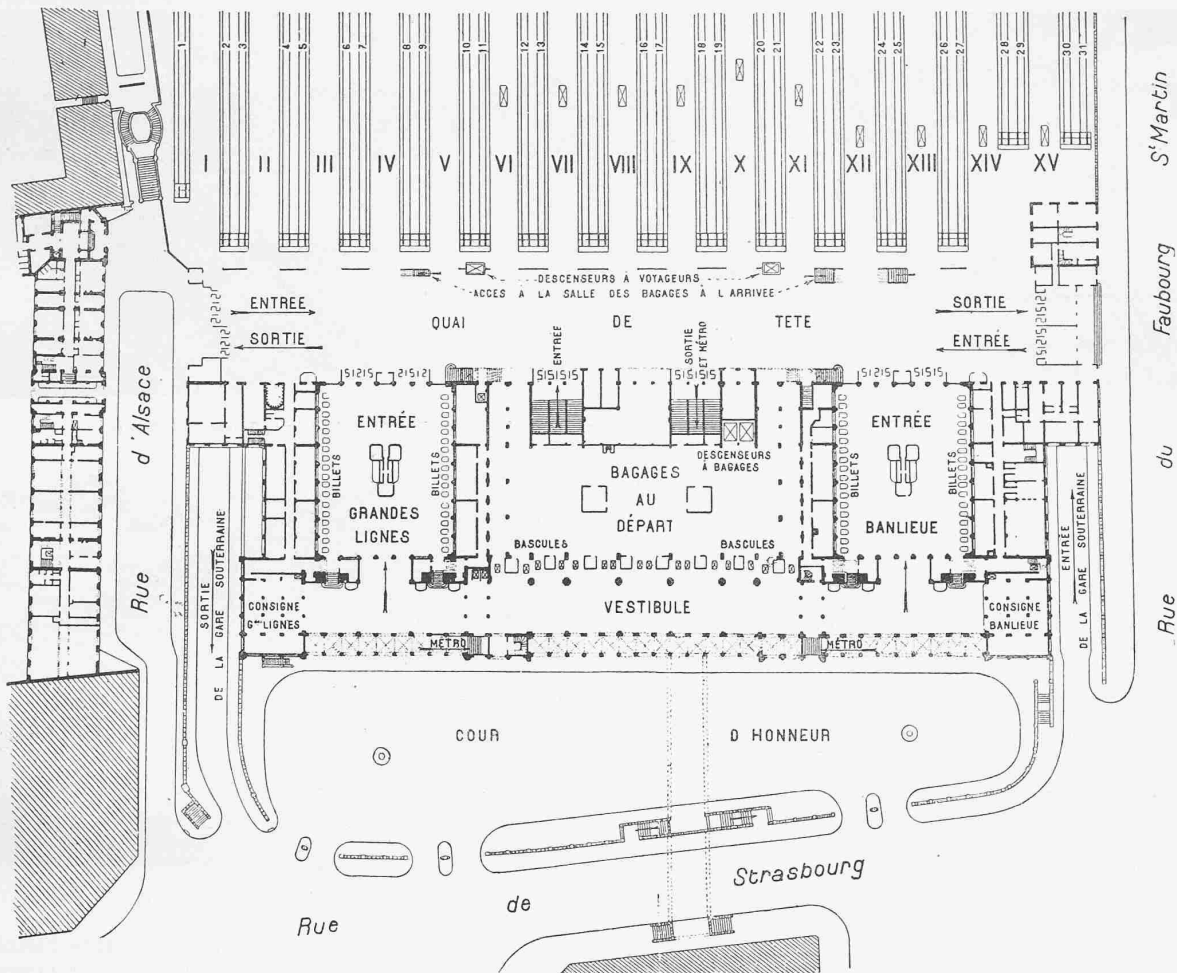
Erweiterung der Gare de l'Est in Paris. Grundriss des Erdgeschosses (in Strassenhöhe). — Masstab 1 : 1500.
